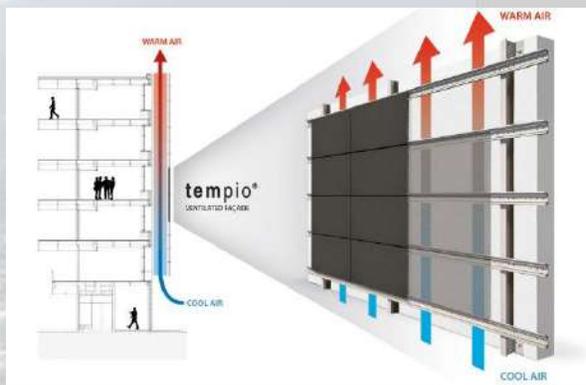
Fachada Ventilada. Fuente: <https://www.tempio.es/fachadas-ventiladas.php>
